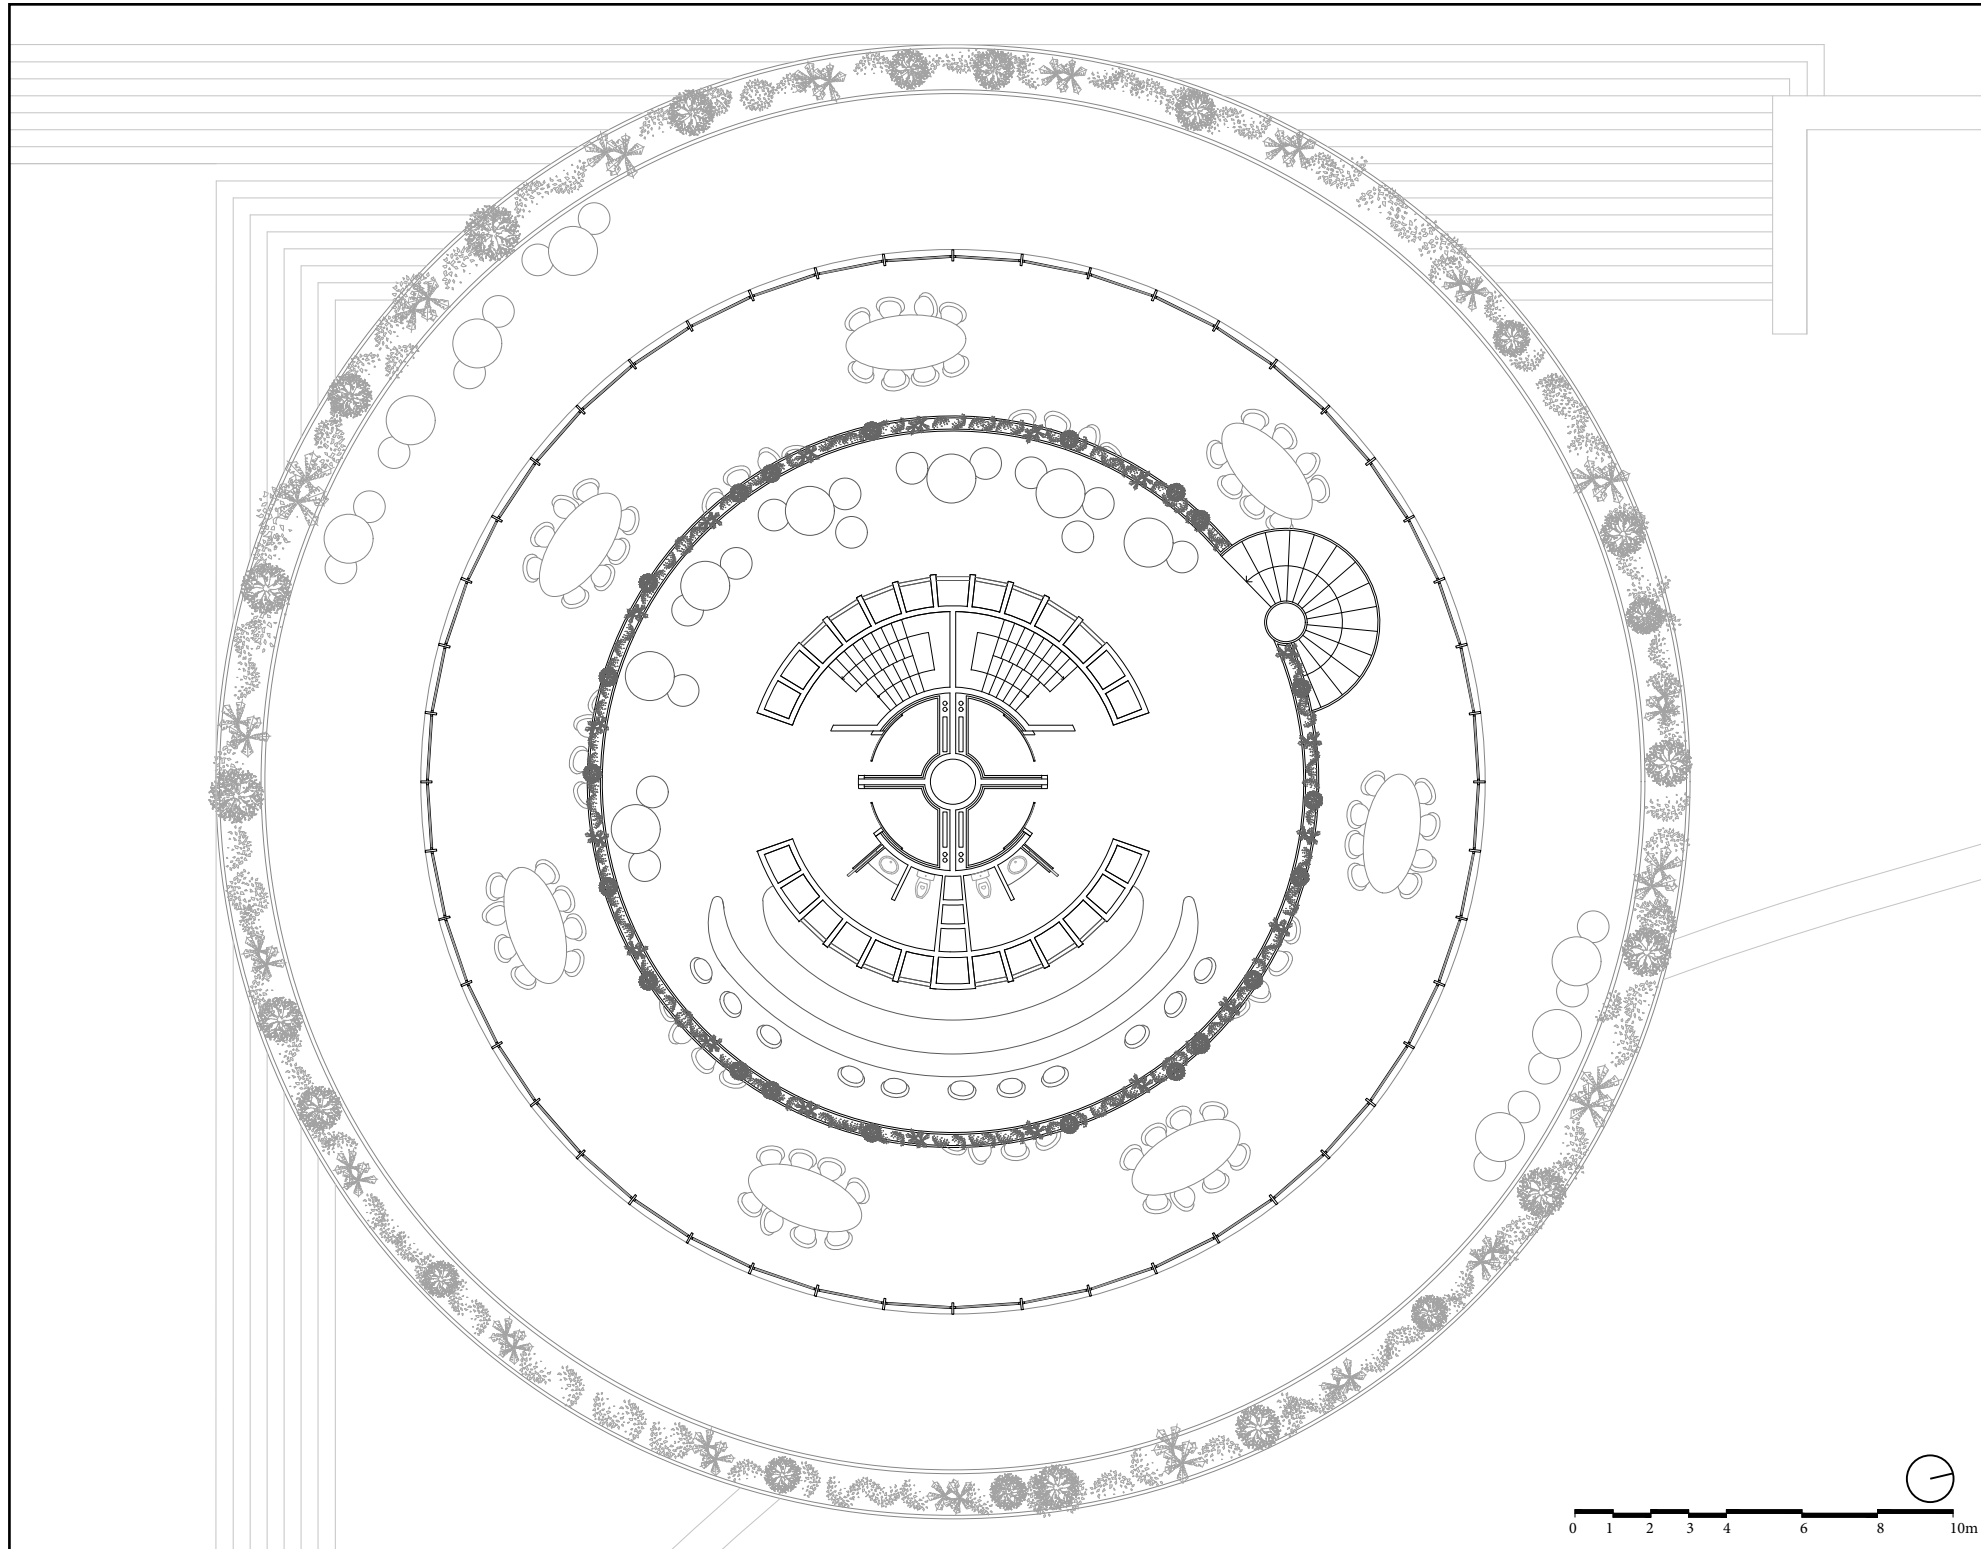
Cuarta Planta. Bar. [Fuente: Autor]
